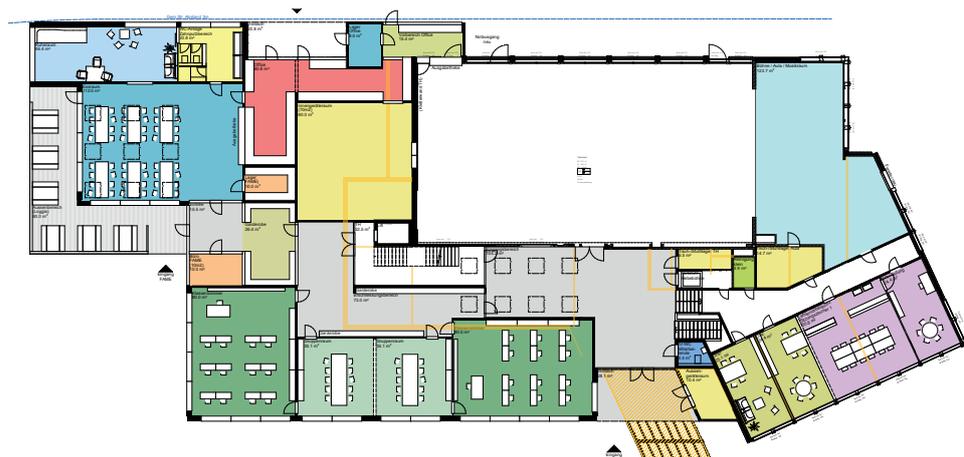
EG Feindispo - Variante 2, 9.4.25 (Hinweis: Vergrößerung siehe Planbeilage)
